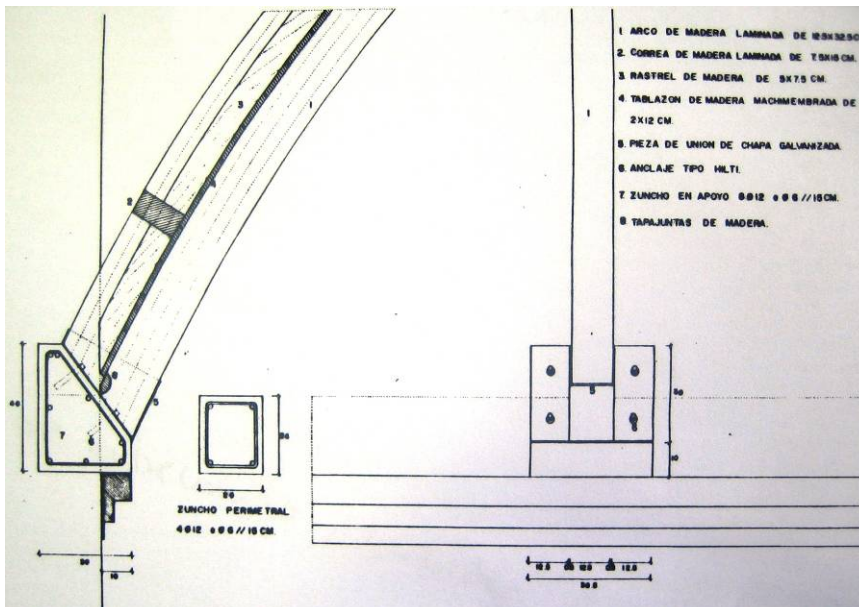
Detalle constructivo del arranque de la bóveda de madera laminada desde un zuncho perimetral de hormigón armado.
